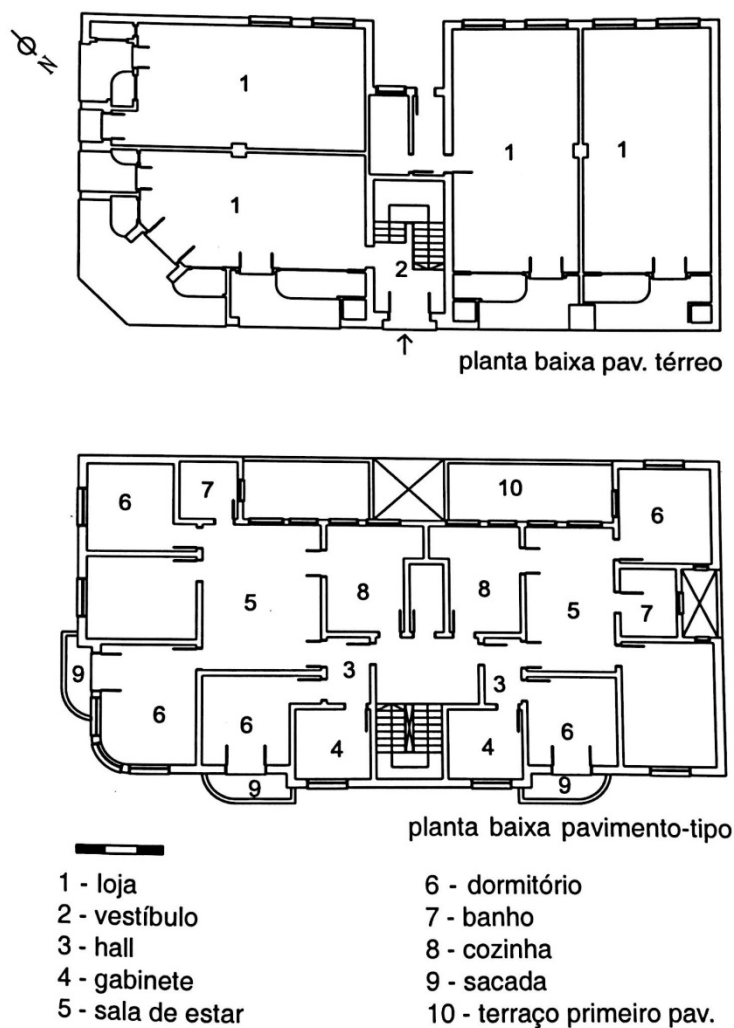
Planta baixa do pavimento térreo e planta baixa do pavimento tipo onde nota-se que o projeto arquitetônico possui funcionalidade e boa ventilação. Fonte: KRAMER; WAIHRICH, 2007, p. 79.
